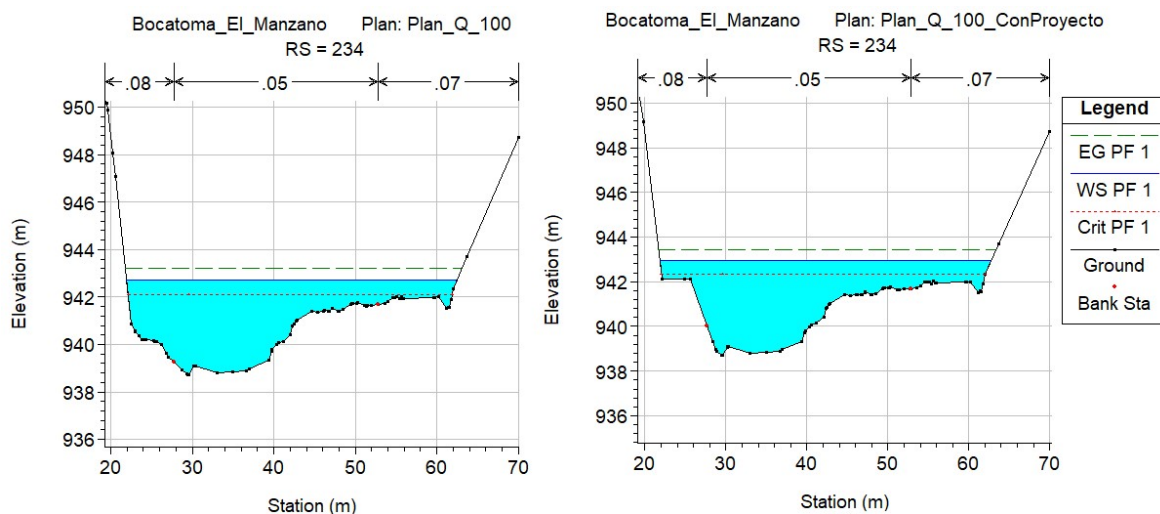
Sección transversal en donde se alcanza la mayor profundidad de escurrimiento para la situación sin y con proyecto
